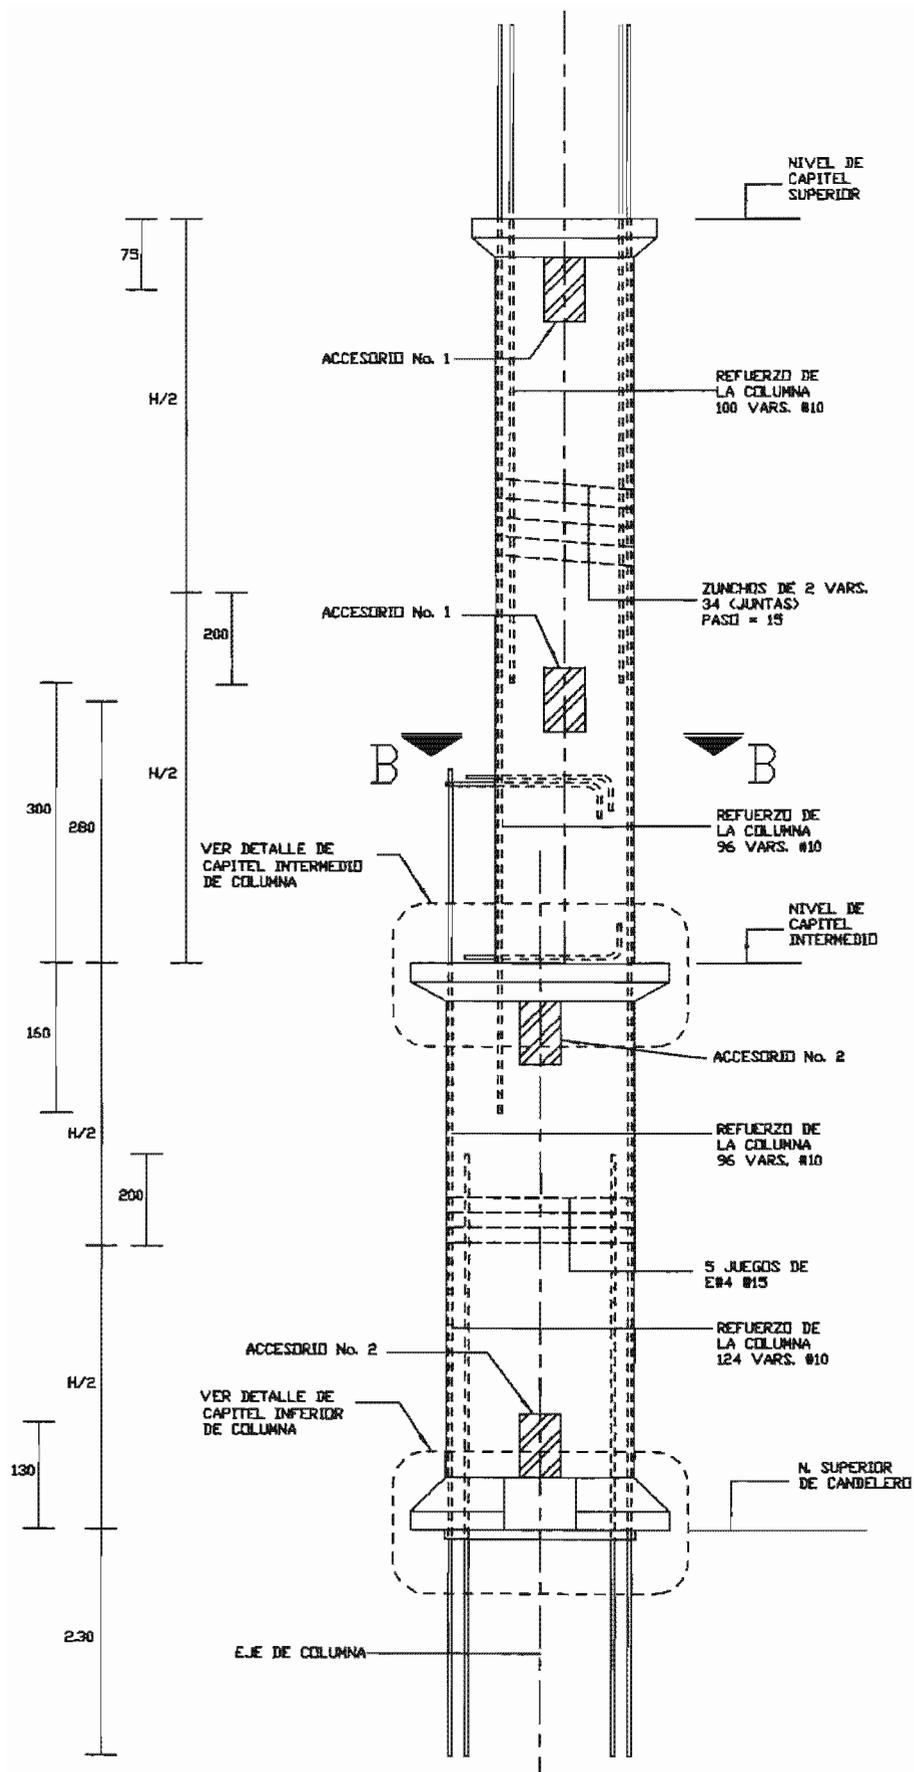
Colocación de acero para columna Tipo I.
